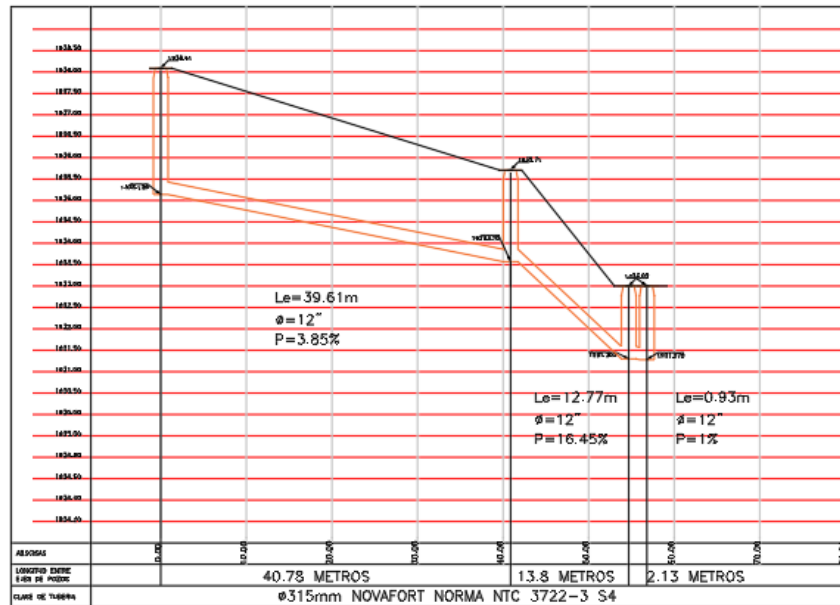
Perfiles Alcantarillado Pluvial Torcaza
